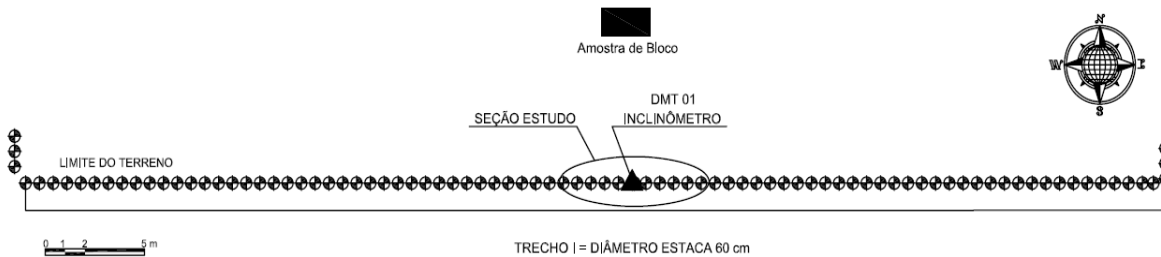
Detalhe da cortina de contenção em planta da Obra (Medeiros 2009).
